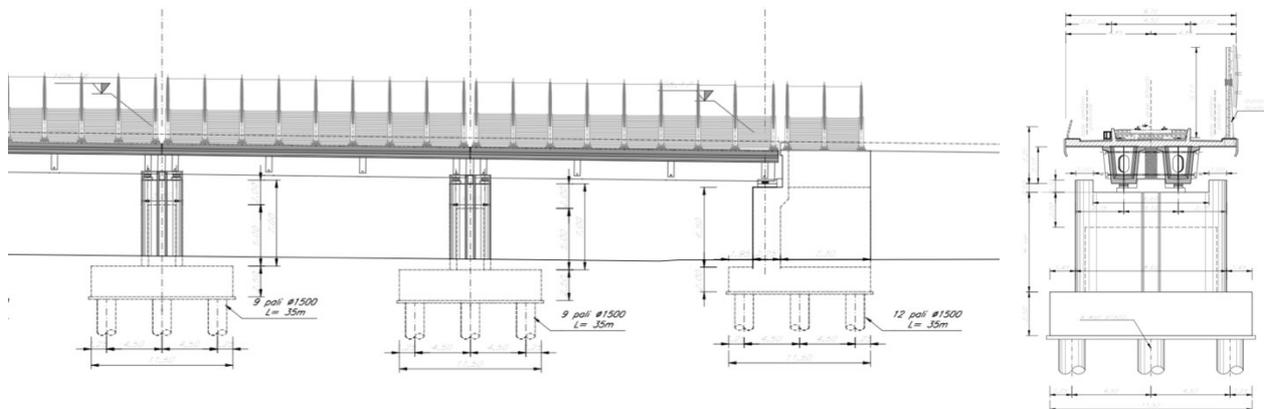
VI12 – Campate costituite da cassoncini in c.a.p - Profilo longitudinale (sx) – Sezione trasversale (dx)
